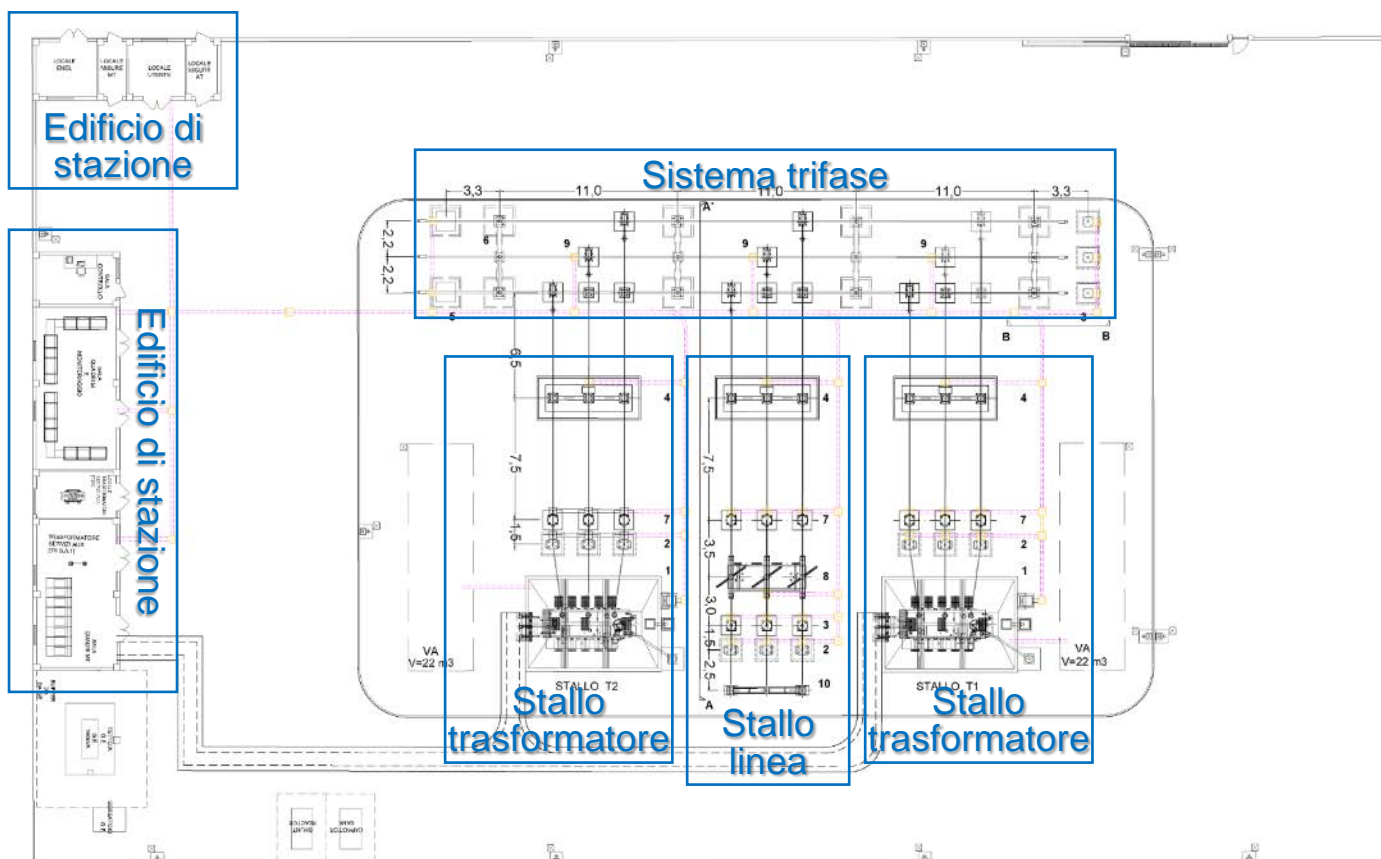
Planimetria dell'impianto con evidenza dei sistemi principali
